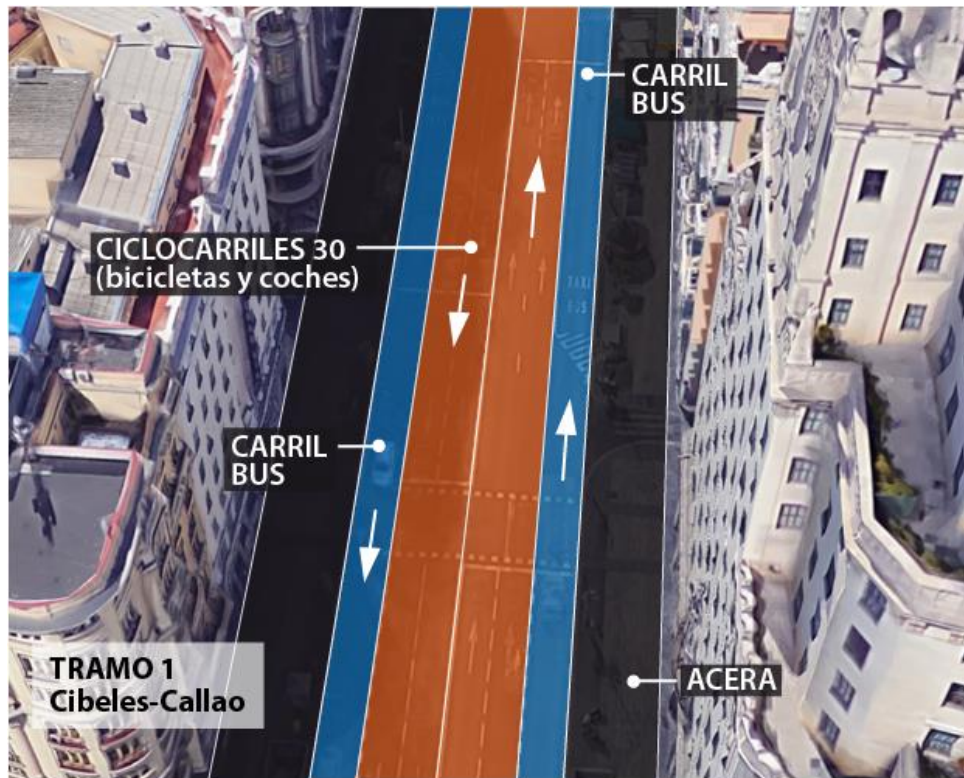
; Planteamiento de la propuesta; Fuente: Archidally
